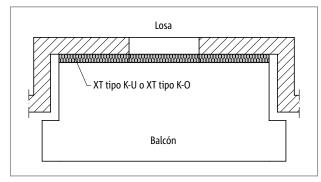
Schöck Isokorb® XT tipo K-U/K-O: Balcón en fachada saliente
